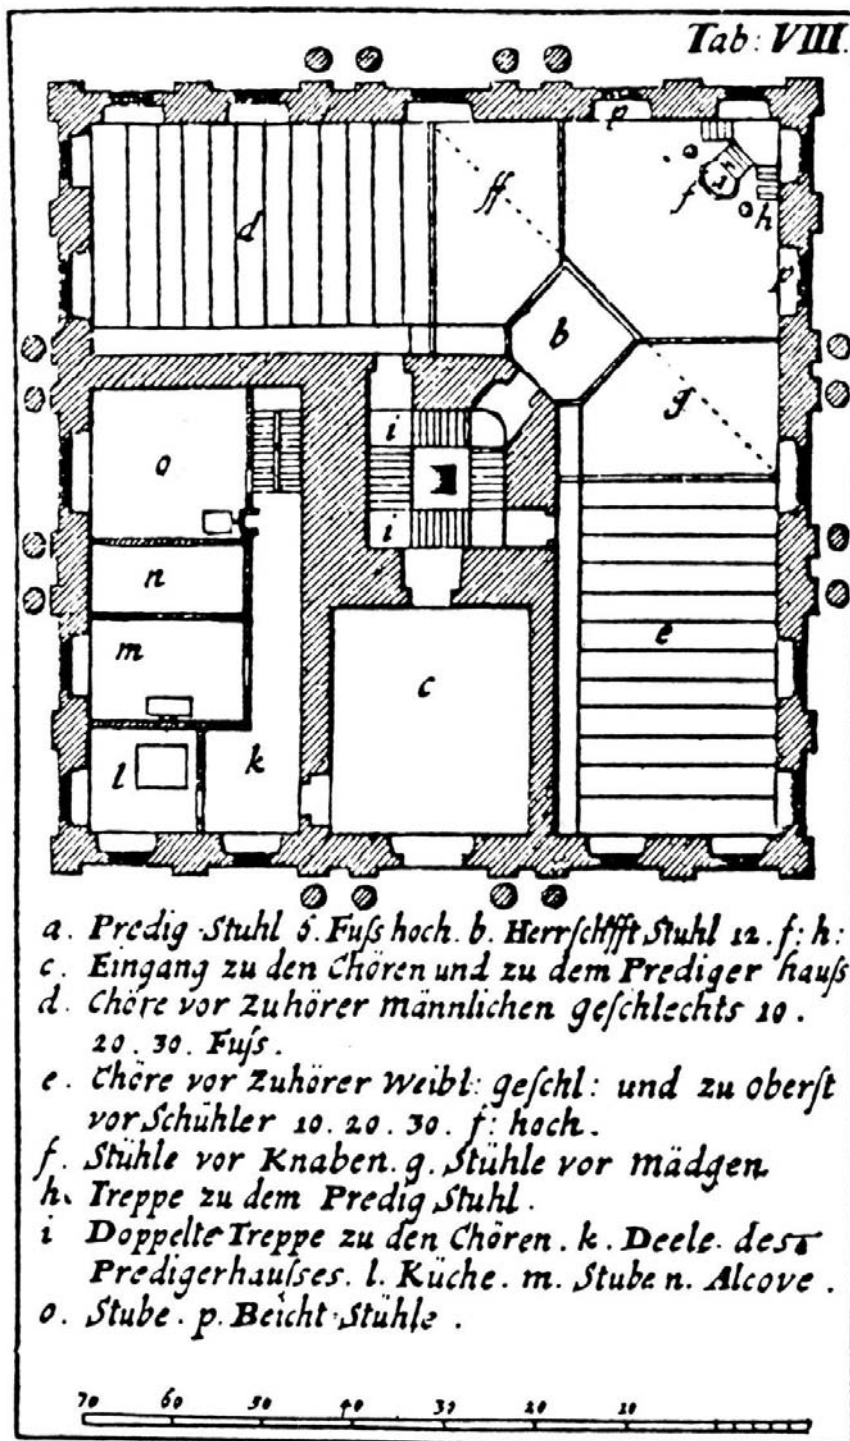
Leonhard Christoph Sturm, Kirchenentwurf (1712), Grundriss Erdgeschoss
